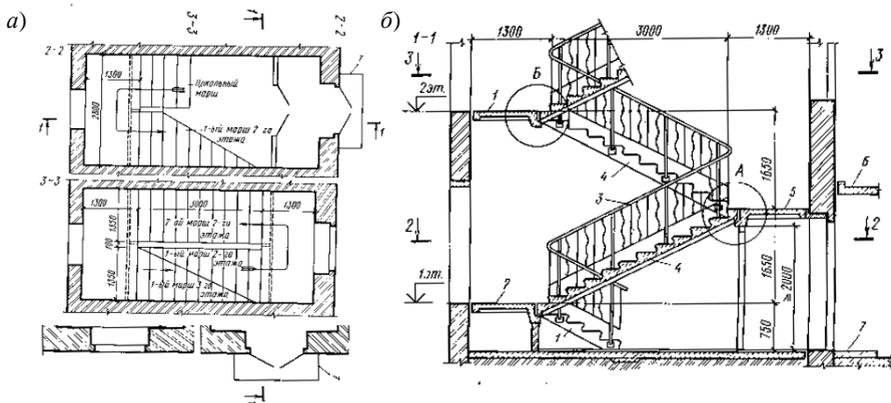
Двухмаршевая лестница (поэтажные планы и разрез)
